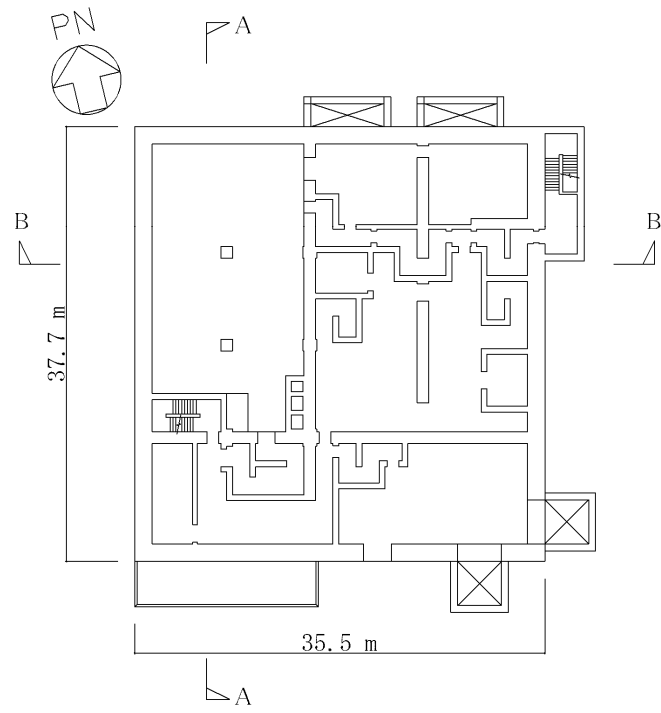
緊急時対策所建屋の概略平面図 (EL. 30.3 m)
